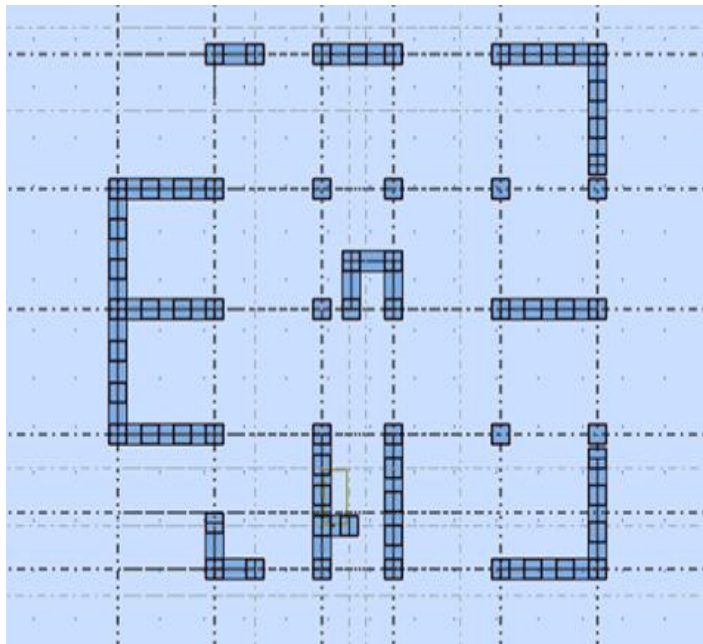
Vue en 2D et plan de la 3ème proposition.
